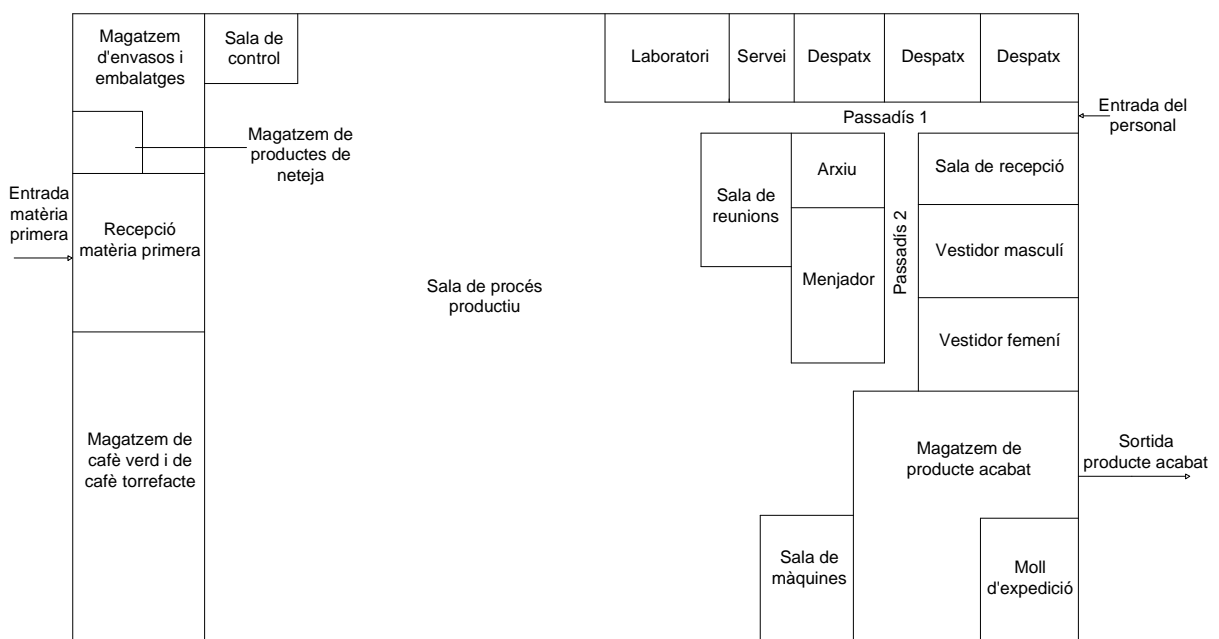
Croquis de la distribució en planta de la indústria projectada.
